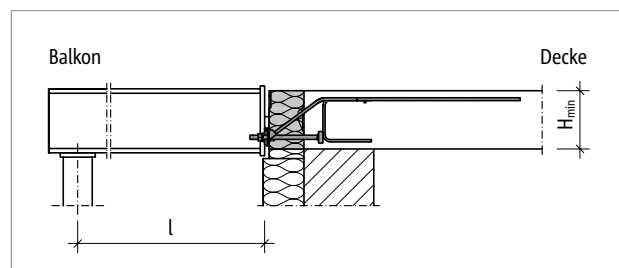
Schöck Isokorb® XT Typ SQP: Statisches System
